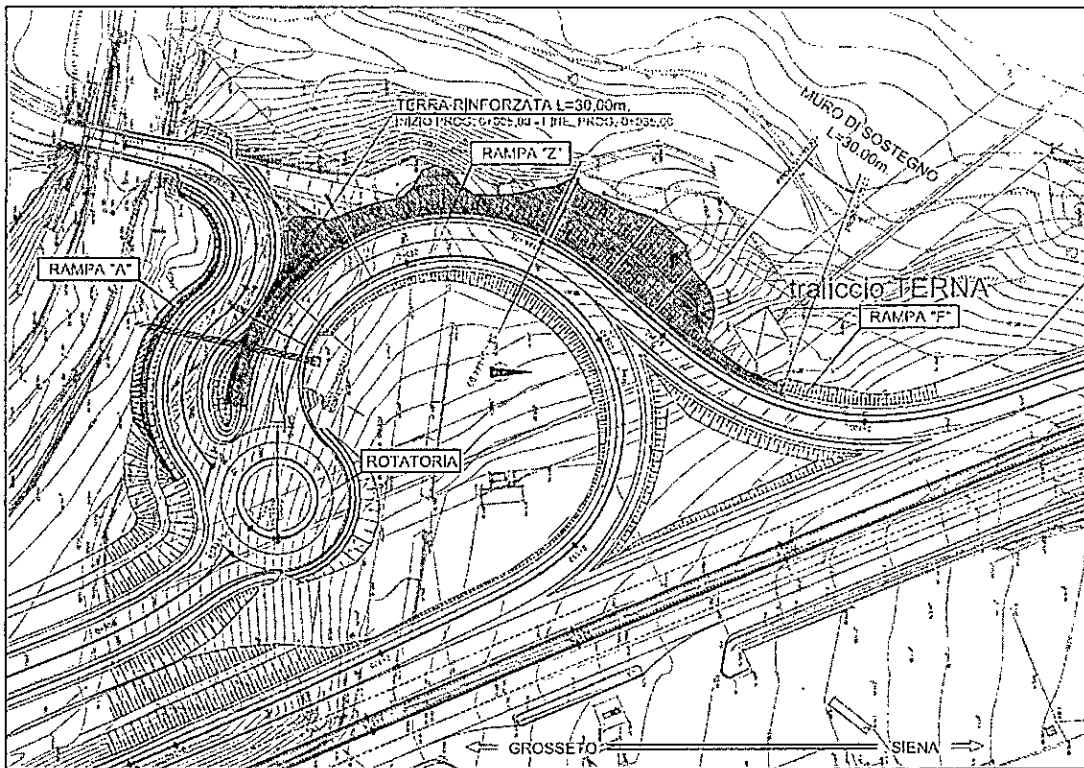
Stralcio planimetrico – Muro terra rinforzata svincolo Lanzo rampa di P.E.
